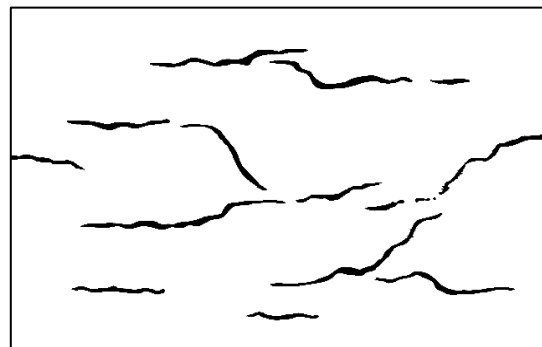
Típica Fisuración por Retracción Plástica (Price, 1982).
